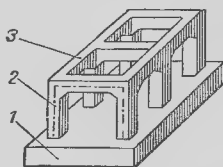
Схема устройства железобетонного фундамента под турбогенератор
